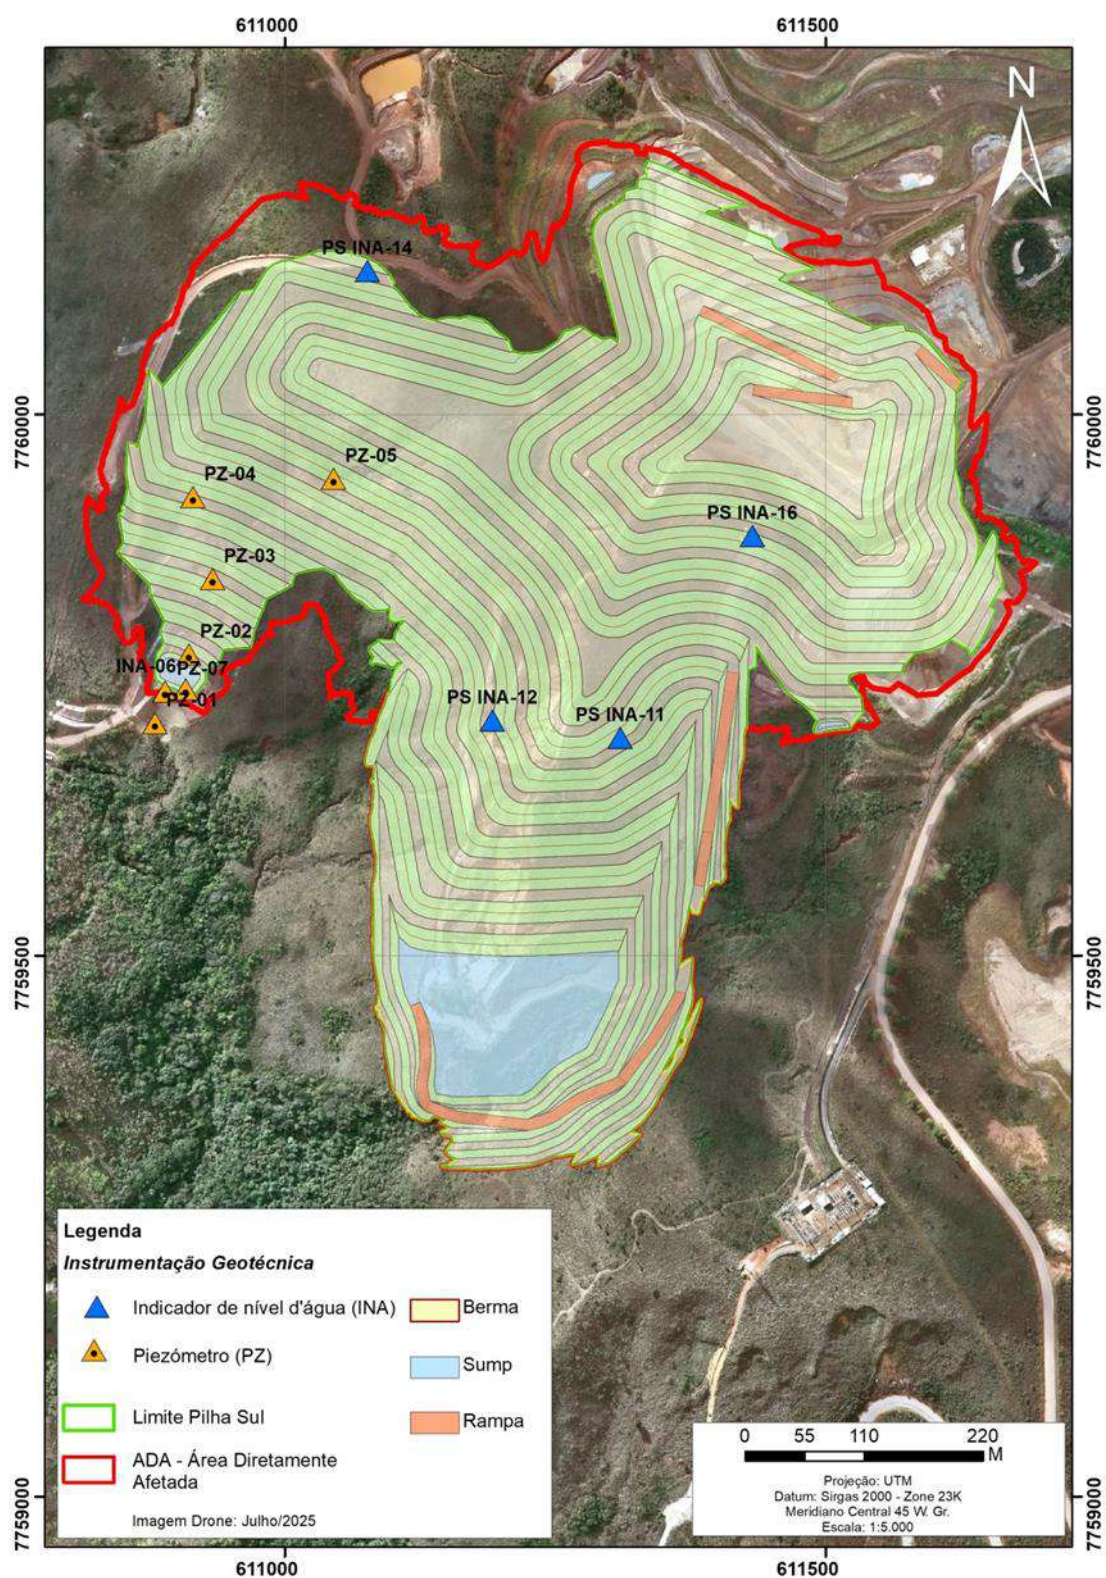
Instrumentação Geotécnica – Pilha Sul.
